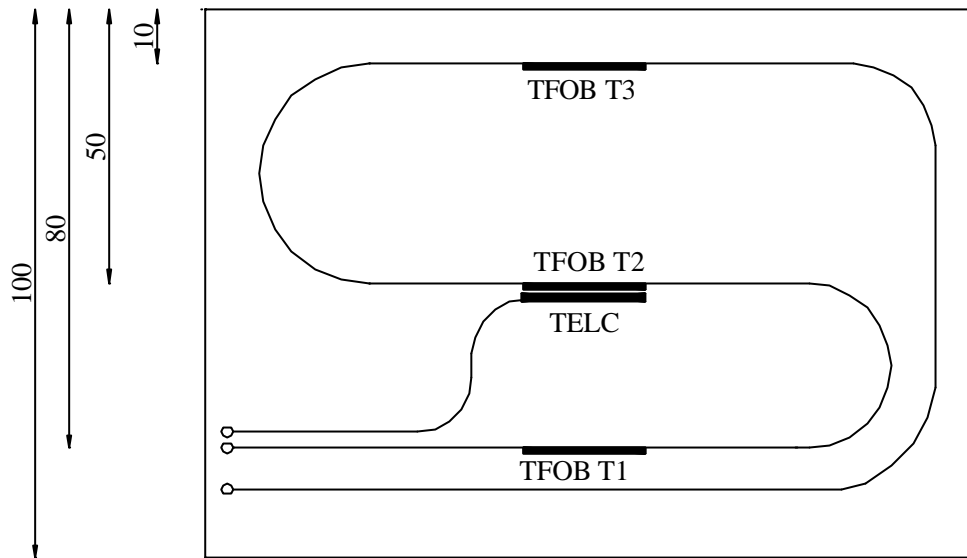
PLANTA DO BLOCO DE TESTES TFOB - SEÇÃO NA METADE DA ALTURA DO BLOCO
